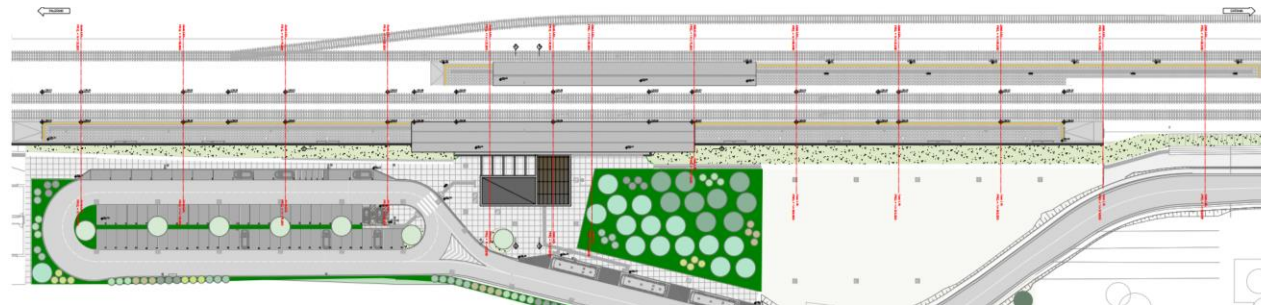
Stazione di Dittaino - Planimetria generale fase provvisoria
